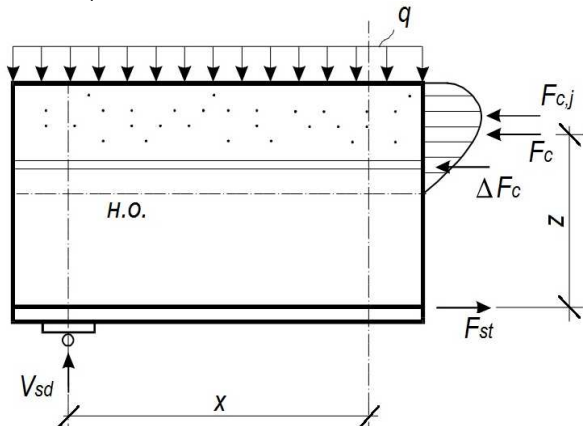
Расчетная схема усилий в сечении согласно [7]
